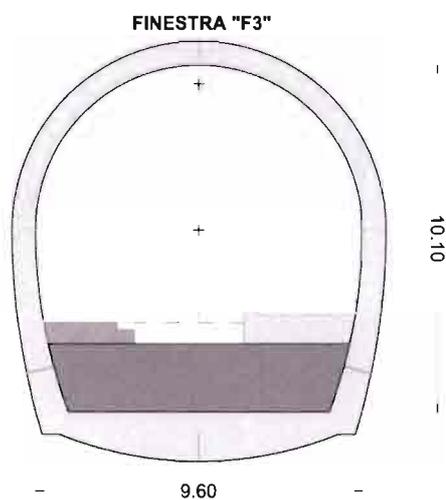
Sezione trasversale finestra Aica-Varna Sud
